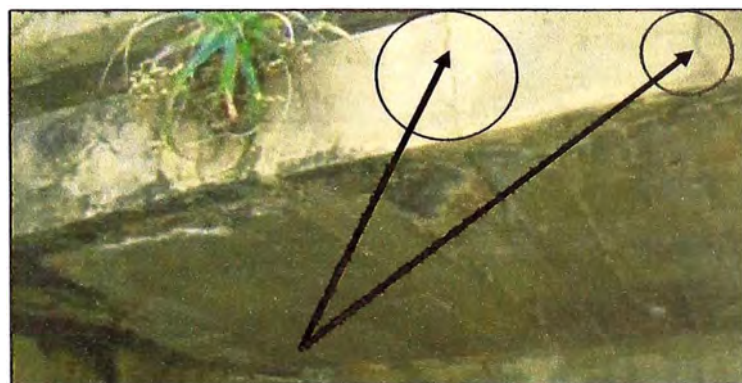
, Inspección Losa lateral Grietas
